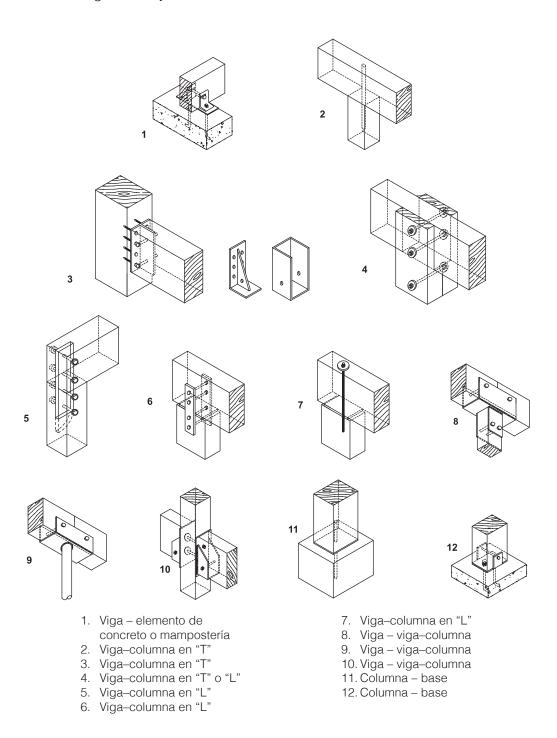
a. Recomendaciones de conexiones articuladas (adaptadas de las referencias 1 y 21).
